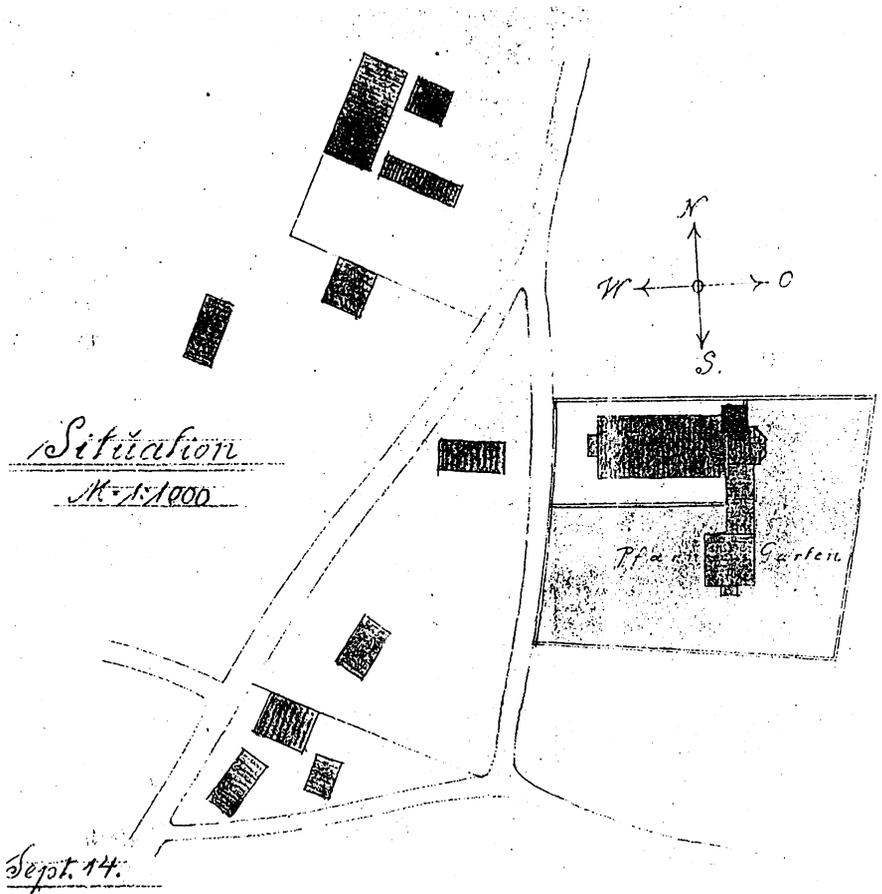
Lageplan zum Kirchenbauprojekt<sup>259</sup>
